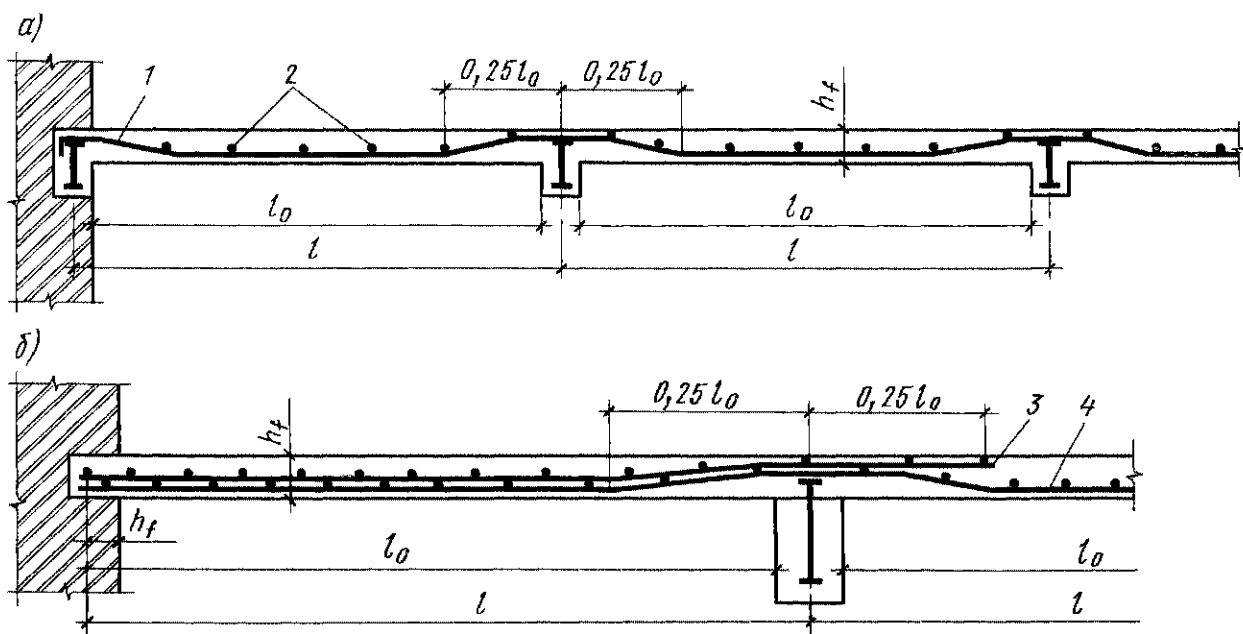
Армирование плиты рулонными сварными сетками
